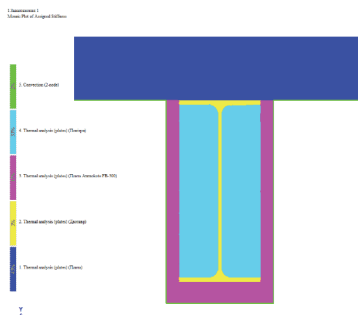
Схема перерізу балки перекриття з вогнезахисними плитами
